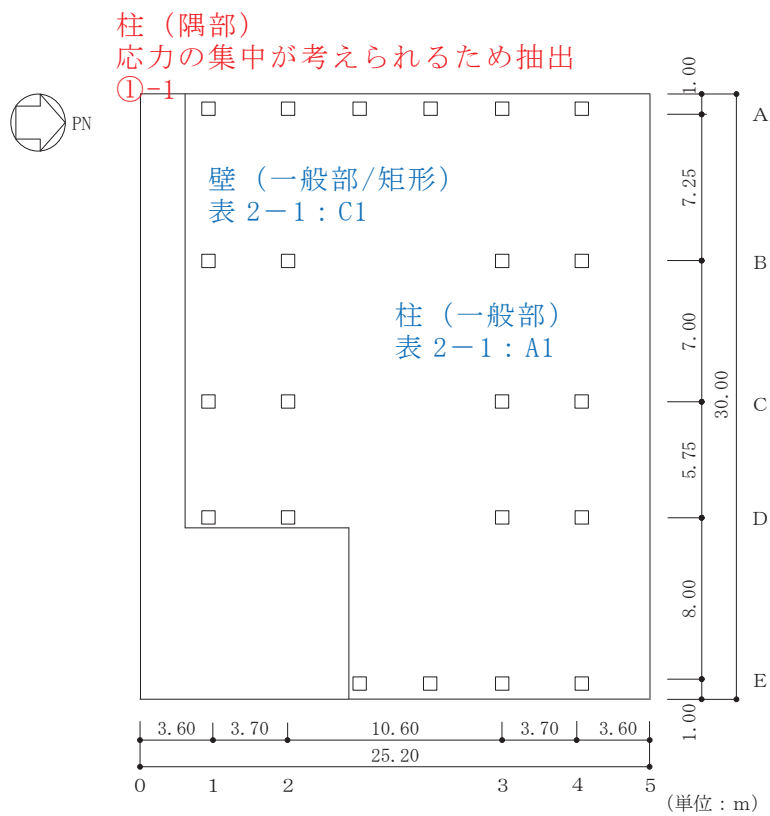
(2) 緊急用電気品建屋の概略平面図 (O. P. 62. 9m)
